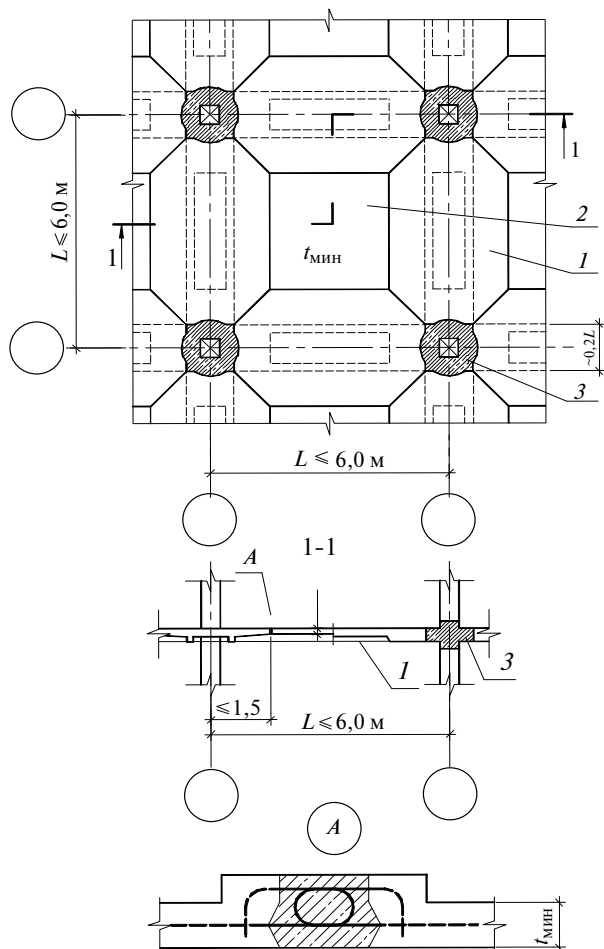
Квадратная ячейка перекрытия с контурными ригелями.
